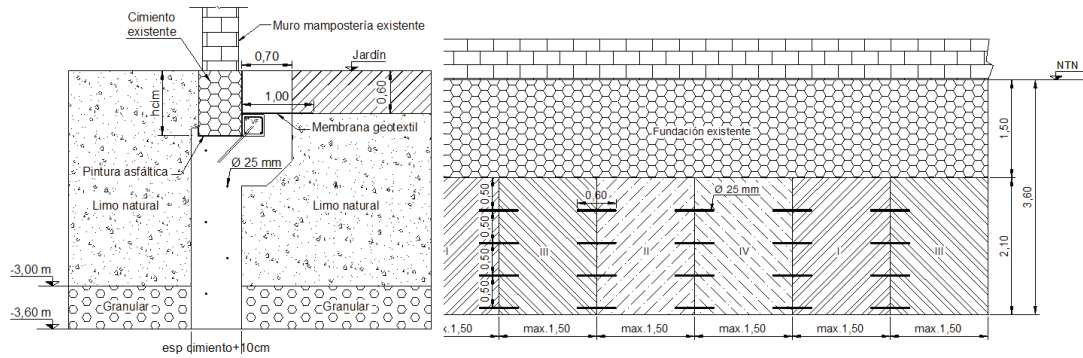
Recalce de fundaciones y orden de construcción de los sectores con hormigón
